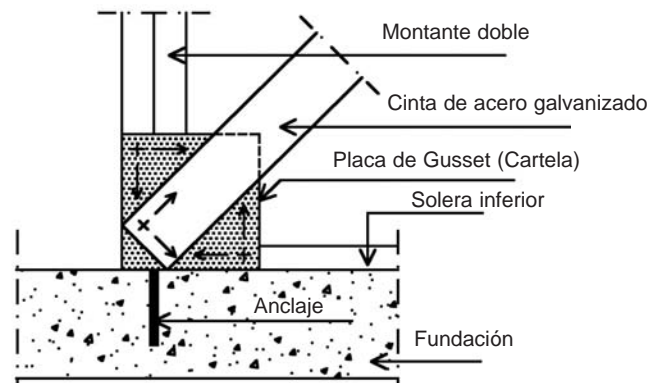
Fijación de las diagonales en los paneles con cartela. (Placa Gusset)
